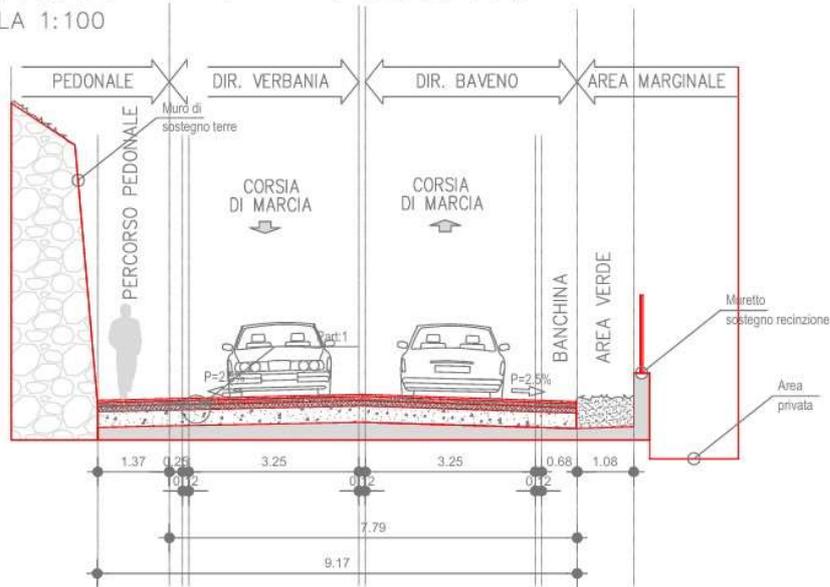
SEZIONE 4 DI PROGETTO - TRATTO STRADALE ALL'ALTEZZA DI VIA ARNOLD
